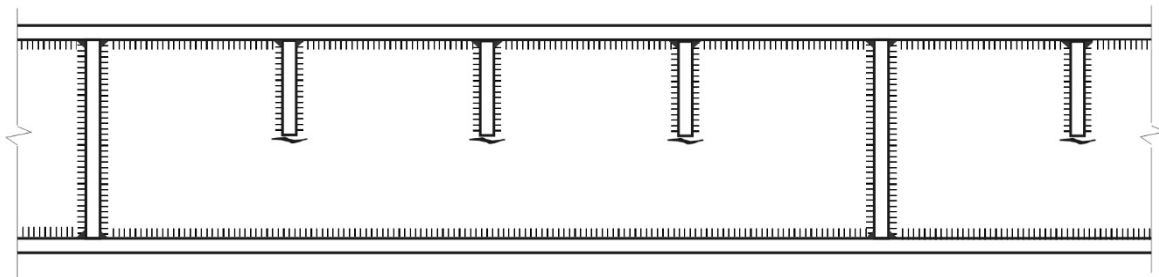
Характерные трещины в сварной подкрановой балке
